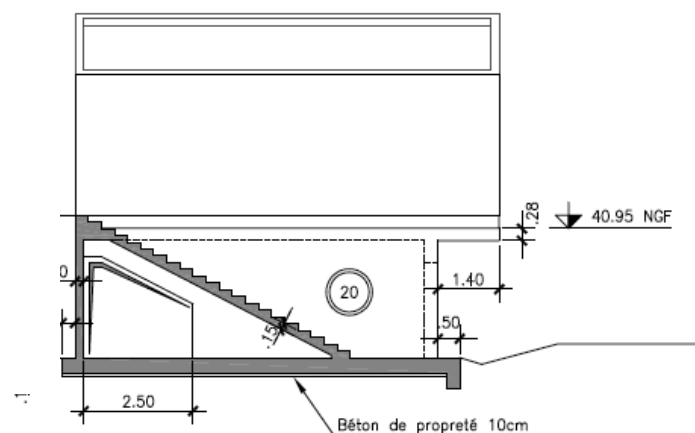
Principe de conception du bâtiment d'arrivée eau Vive
